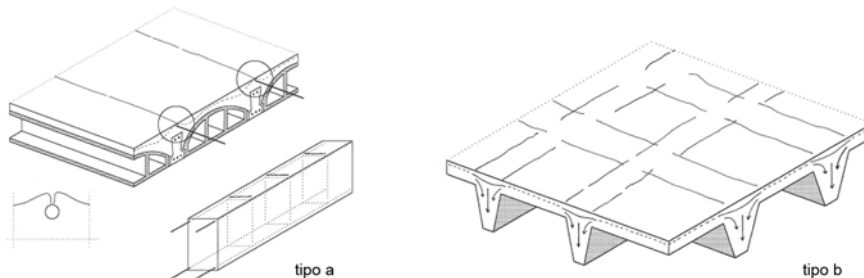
Fisuras de asentamiento plástico. Tipos a y b.
